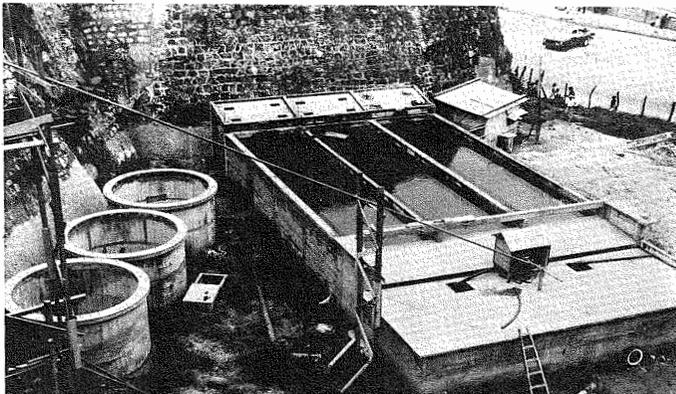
Planta biológica Municipal en construcción. Para tratamiento de basuras de Mercado Municipal. Ver Cuadro No. 1.
